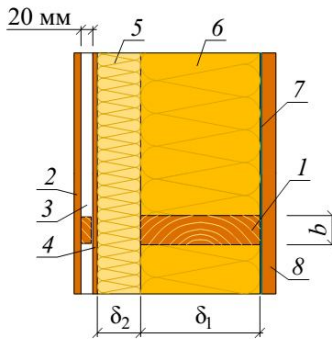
Конструкция наружной стены с наружной жесткой тепловой изоляцией: 1 – рейка (шаг 0,6 м); 2 – наружная облицовка; 3 – 20 мм вентилируемого слоя; 4 – обшивка; 5 – 50 мм жесткой тепловой изоляции; 6 – тепловая изоляция; 7 – пароизоляция; 8 – внутренняя облицовка
